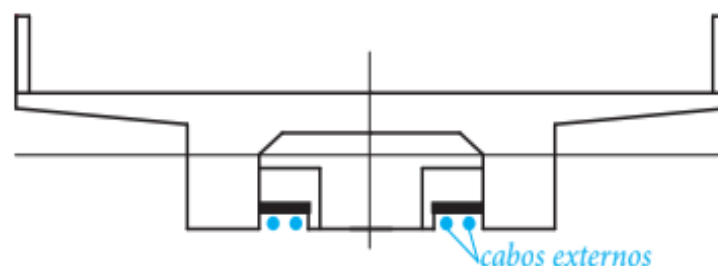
Armadura de protensão externa. (Bonilha et. Al.; 2016)
